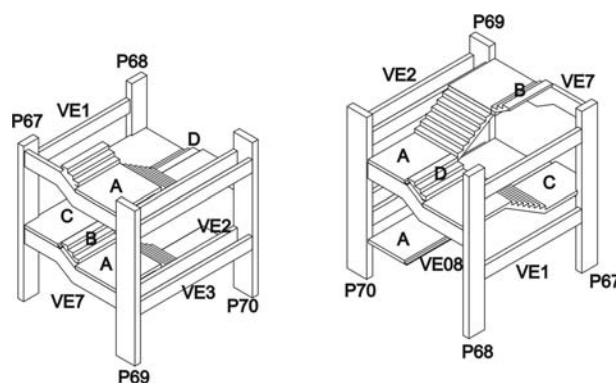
protótipo virtual do primeiro nível de pilares com vigas de amarração e lances apoiados da escada 3.
